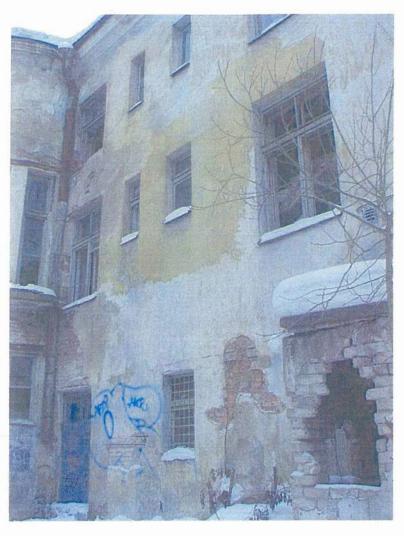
Северо-восточный дворовой фасад здания. Фото с севера.
